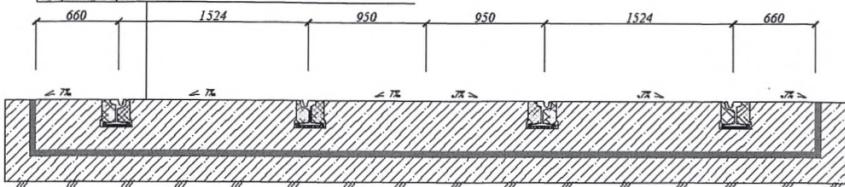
Конструкции трамвайного пути на железобетонном основании с прирельсовыми вкладышами и виброизоляционными матами
